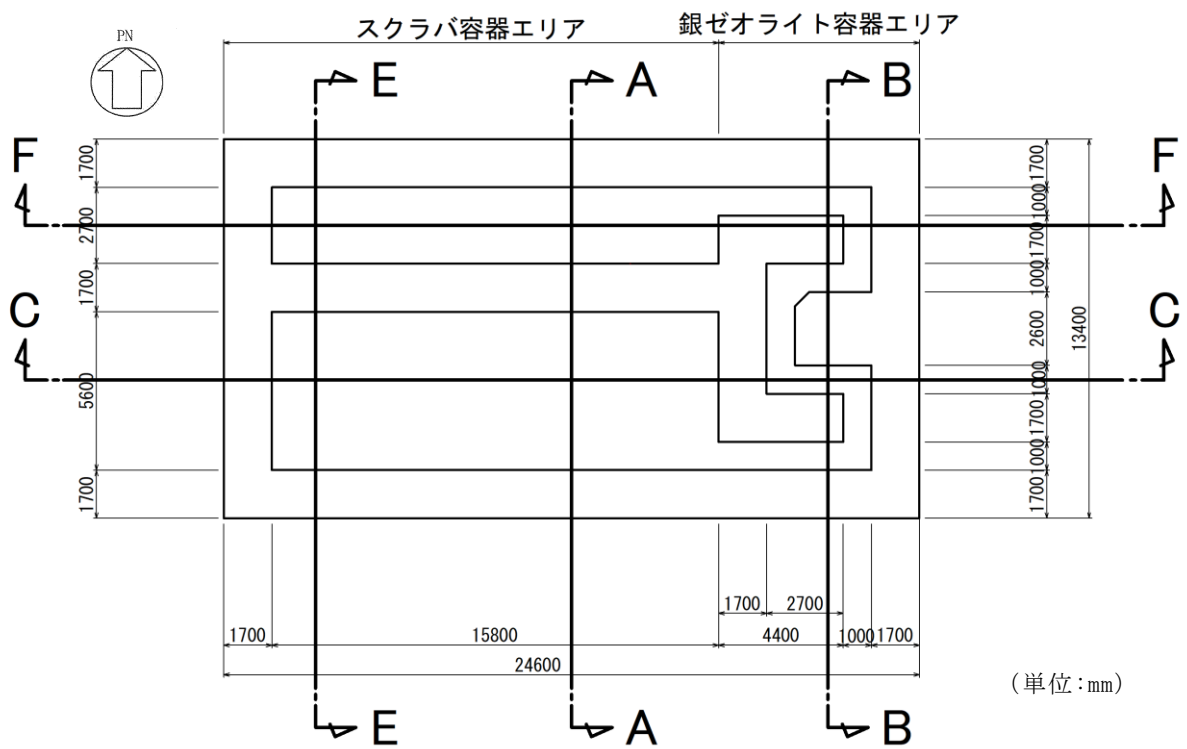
第 1 ベントフィルタ格納槽 平面図 (EL 3.00m)
